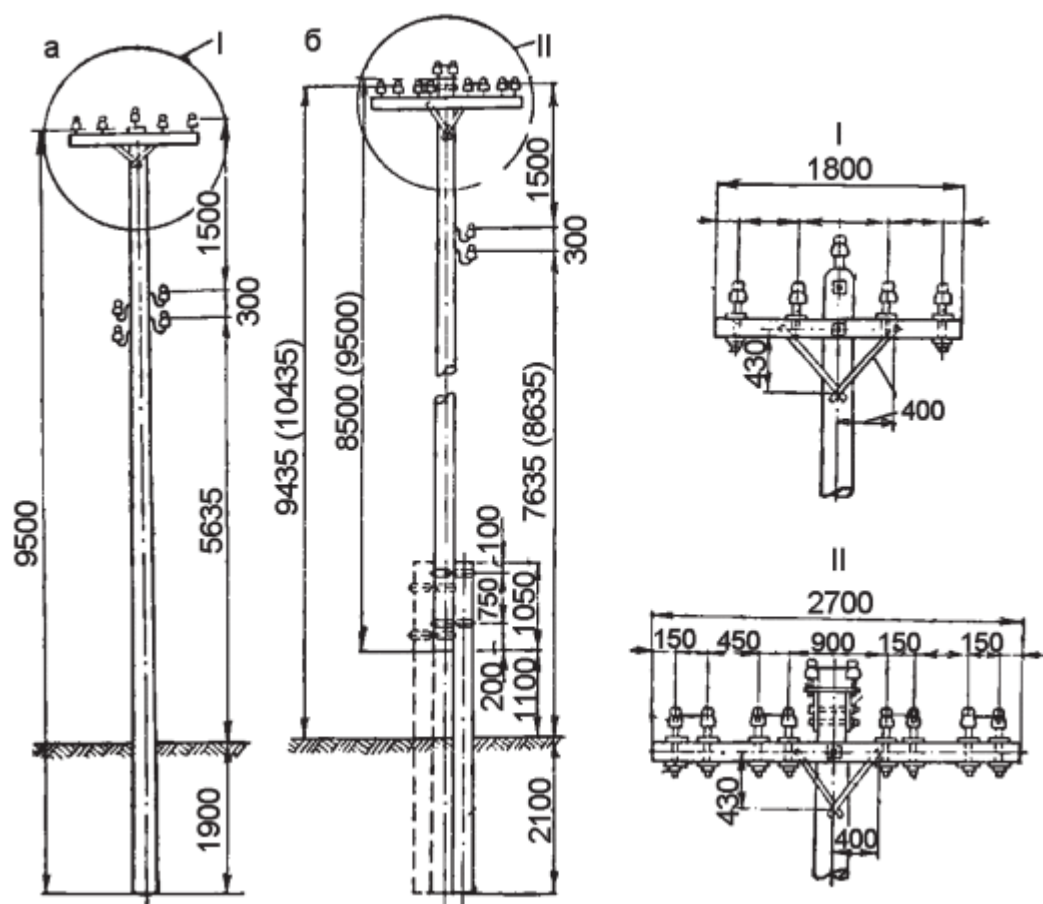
Промежуточные деревянные опоры с траверсой: а – цельная опора ПН-1Д; б – переходная опора с железобетонной приставкой ППН-2(3)ДБ
